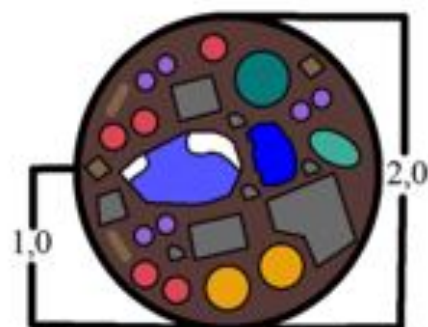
Генеральний план кам'янистої гірки (розробка автора)
